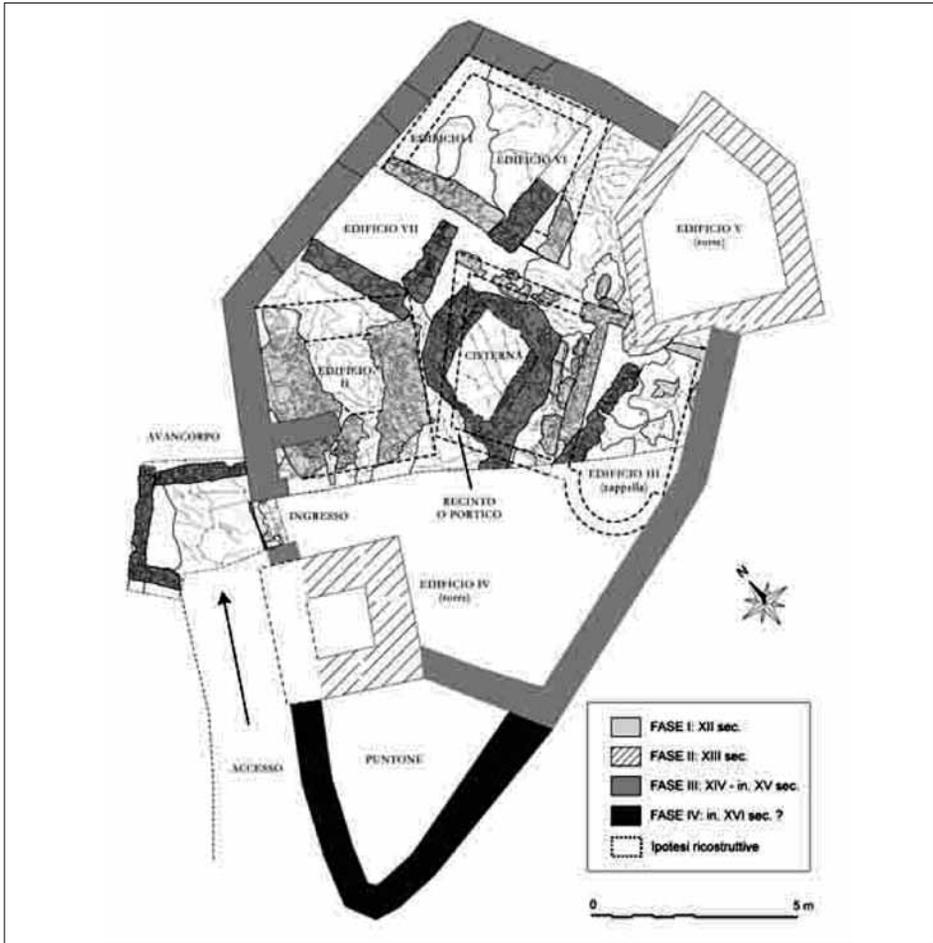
Pianta delle strutture del castello di Cimbergo (da Leoni, Breda 2011)
